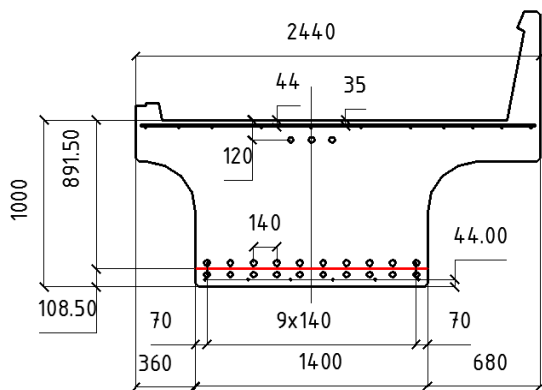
Плитна прогонова будова суцільного перерізу з попередньо-напруженою арматурою. Варіант № 1
